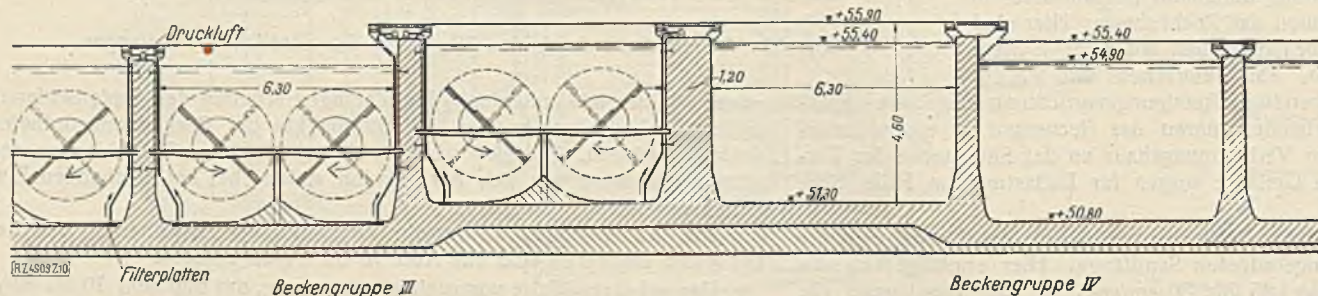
Querschnitt durch die Belüftungsbecken.
